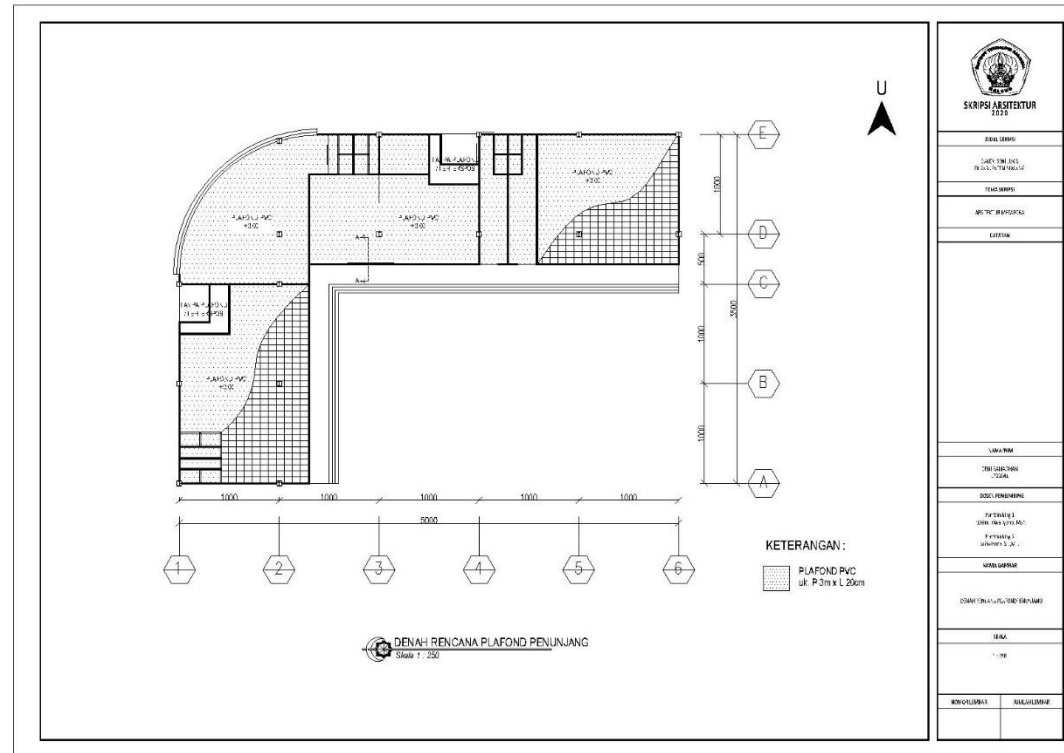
12. Rencana Plafond Bangunan Pengelola
